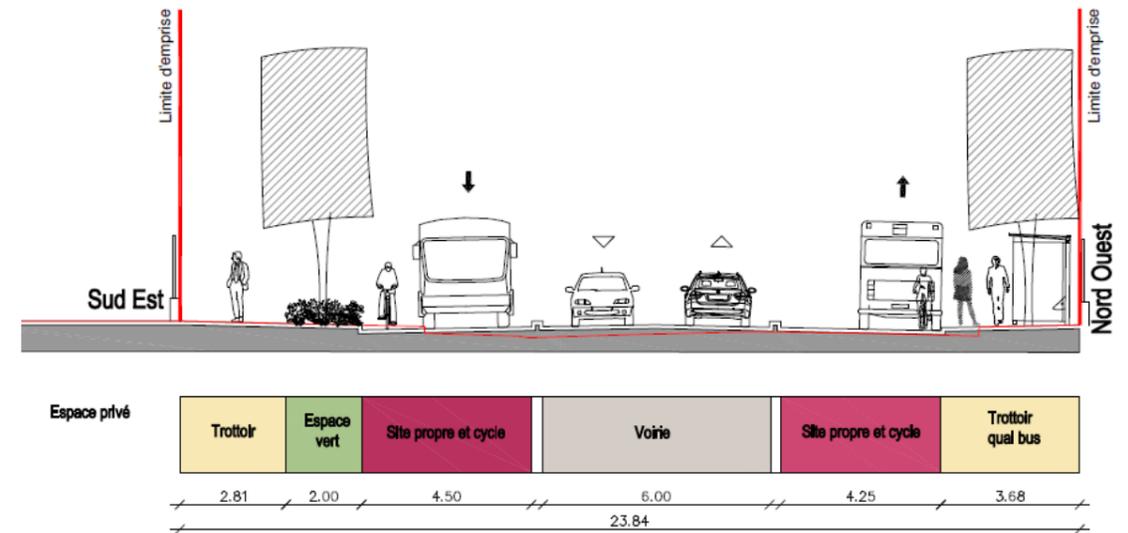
Coupe type en section courante sur le boulevard Léon Feix
